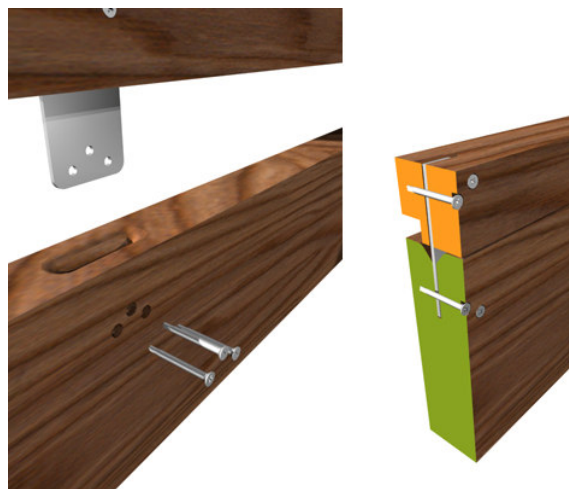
Proposta final: os painéis verticais unidos aos horizontais por uma chapa com cantos arredondados, fixada por parafusos com rosca auto cortante e ponta auto perfurante.
